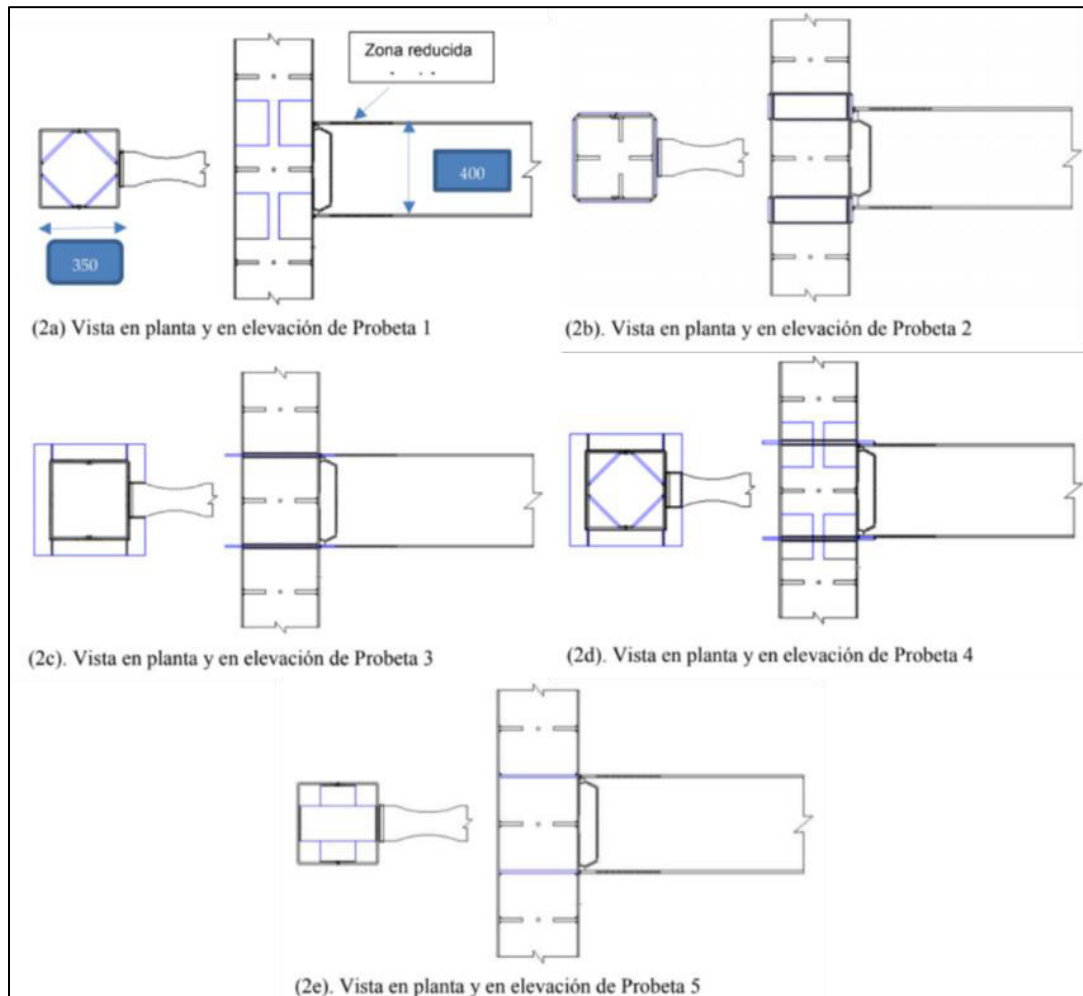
Probetas para evaluación de conexiones entre columna RCFT y vigas metálicas tipo I.
